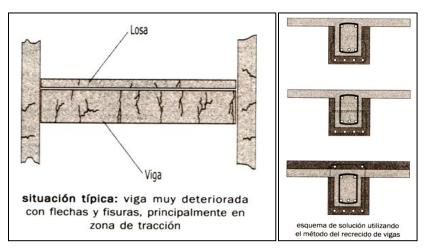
Esquema básico de solución utilizando el método refuerzo estructural con recrecido de viga ó columna Fuente: Libros de Rehabilitación y mantenimiento de estructuras en concreto, Paulo Helene, Brasil.
